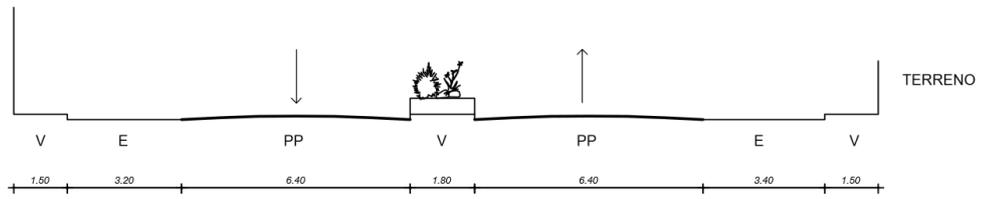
Sección Vial Av. Artesanal "E"- A-A'
